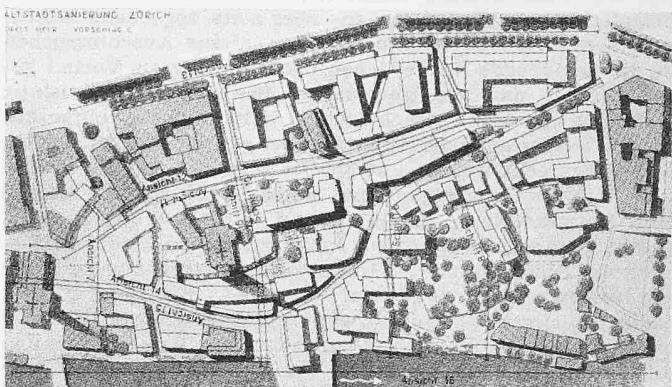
Lageplan der linksufrigen Altstadt (Nord rechts)
